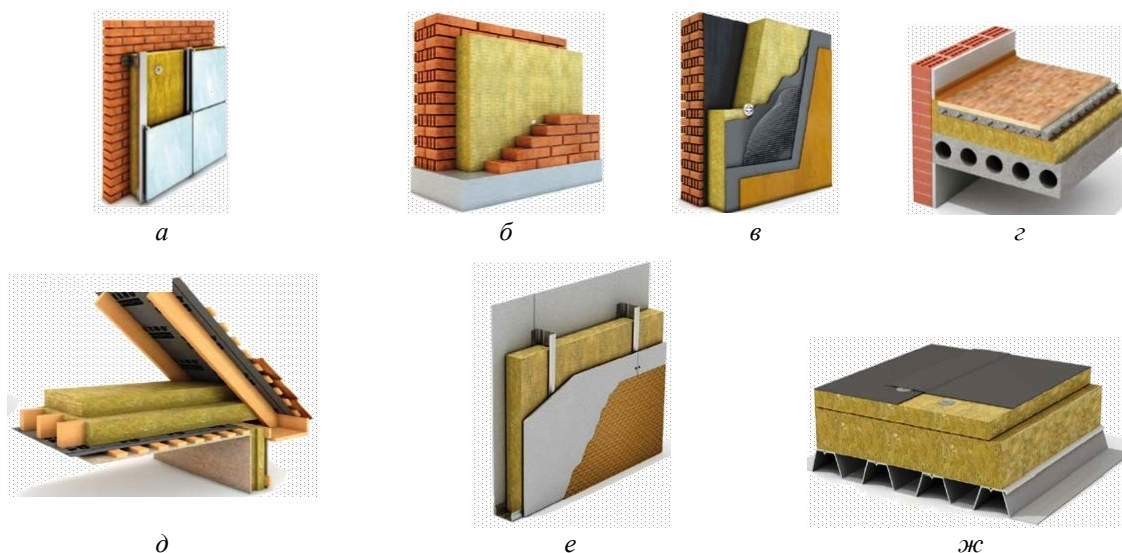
Використання утеплювача для різних будівельних конструкцій, будівель і споруд медичних установ (початок): а – зовнішнє утеплення стін; б – утеплення всередині стін; в. внутрішнє утеплення стін; г – утеплення всередині перекриття; д – утеплення горіщного покриття; е – утеплення перегородок; ж – облаштування перекриття за профнастилом
